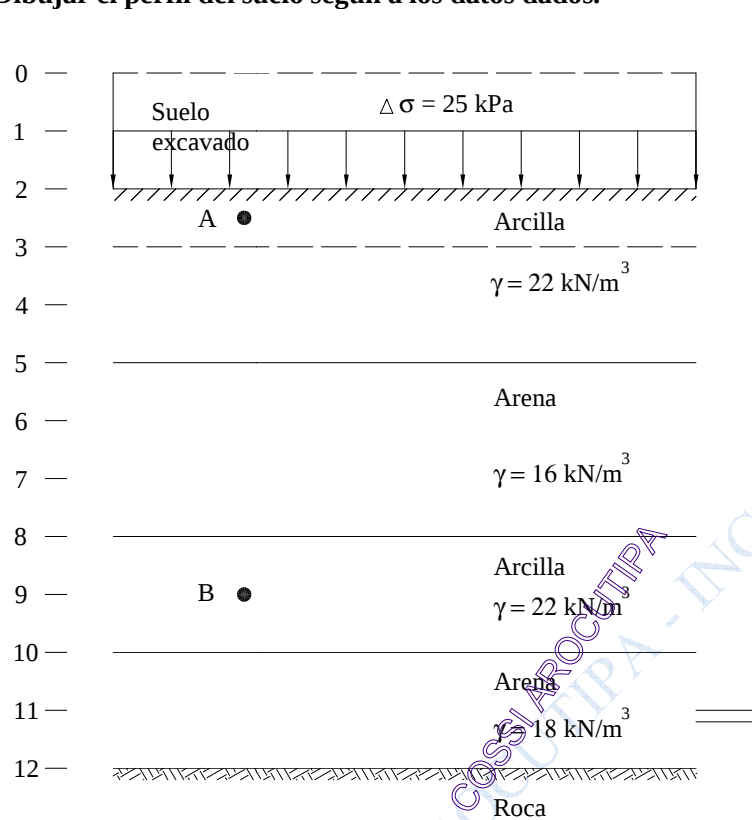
Perfil del suelo inmediatamente después de la excavación (corto plazo).
